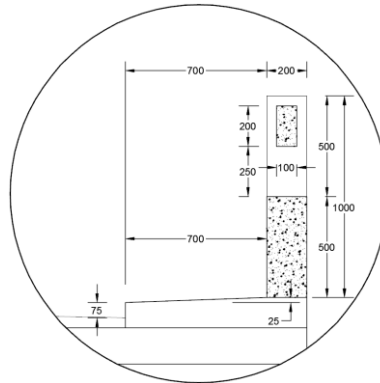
Dimensiones de las Barandas del puente Sección transversal.
